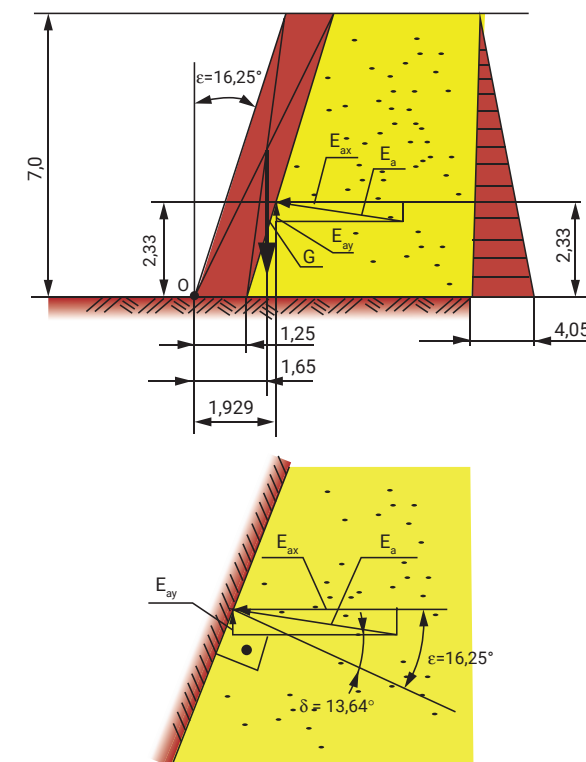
Расчетная схема подпорной стены устоя моста для расчета устойчивости положения на опрокидывание
